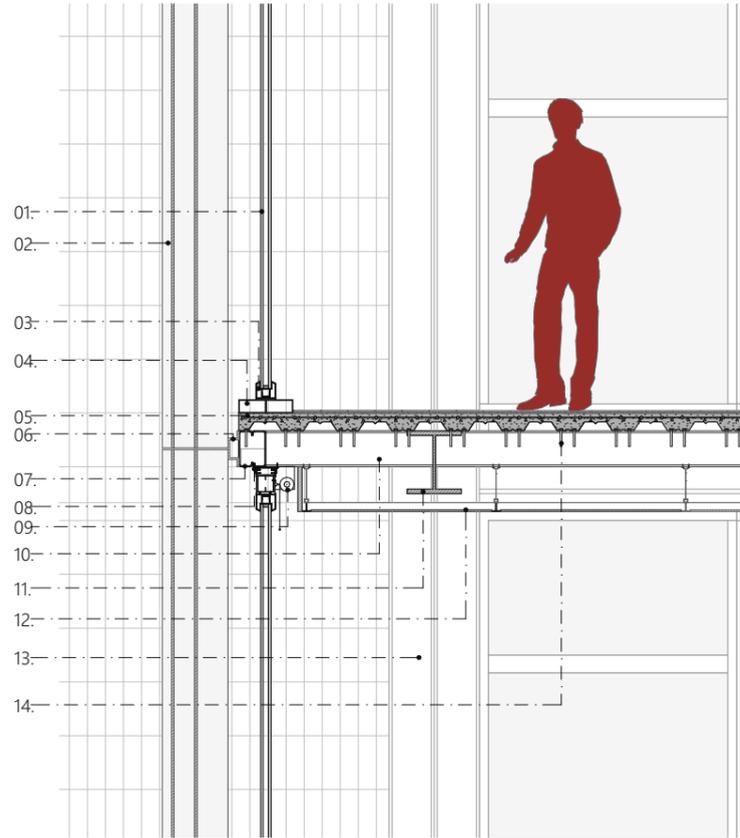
Detalle constructivo Gráfico: Elaboración propia
